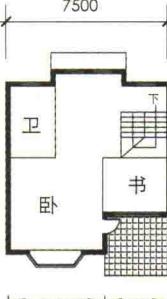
面宽较大、平面方正的第二代联排住宅平面图
